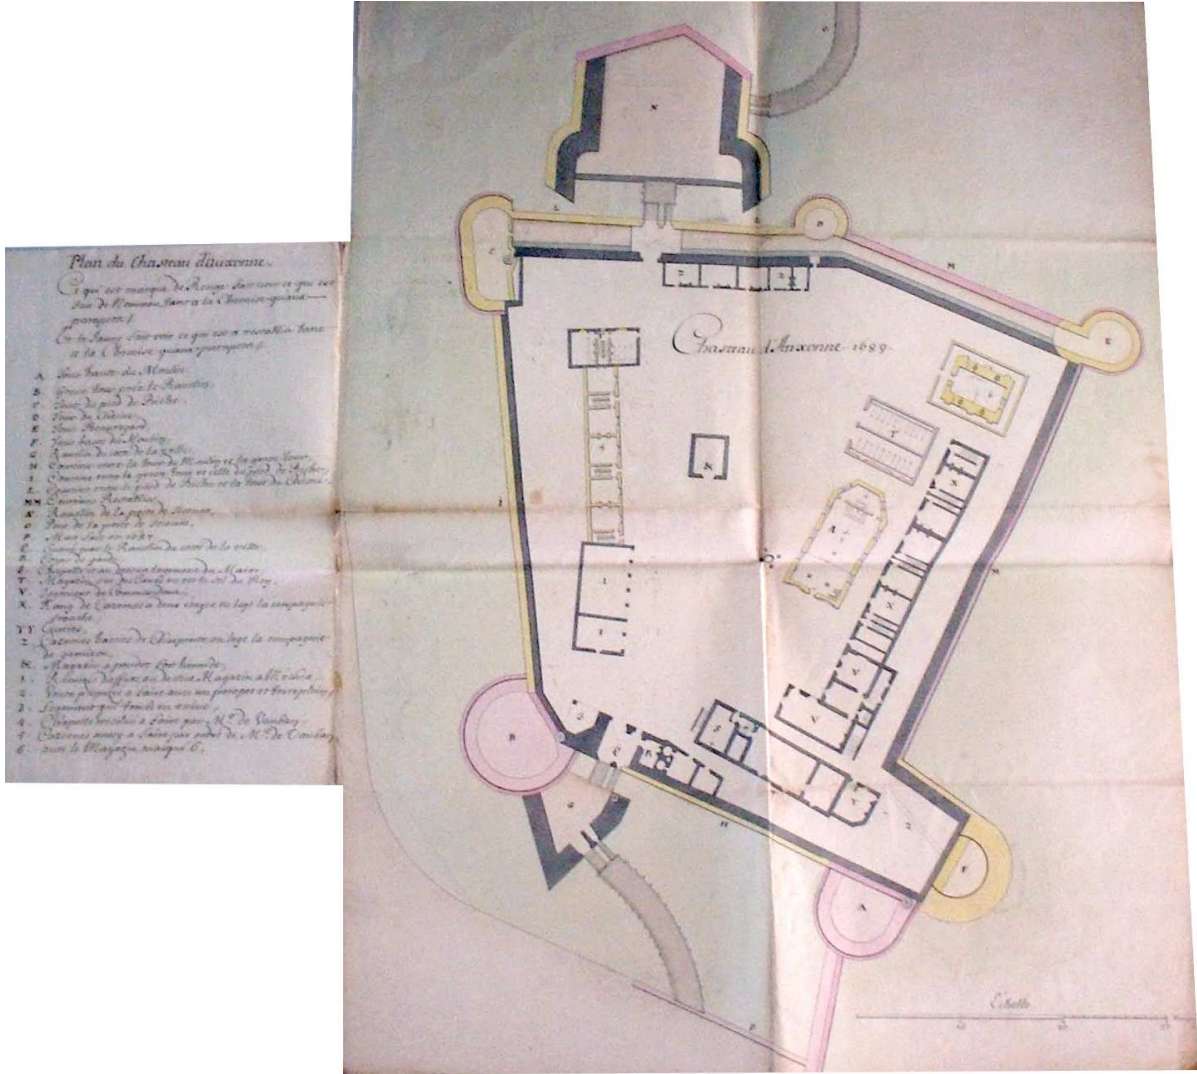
Plan du château d'Auxonne en 1689 (SHAT, art. 8 sec. 1 , Auxonne car. 1)
